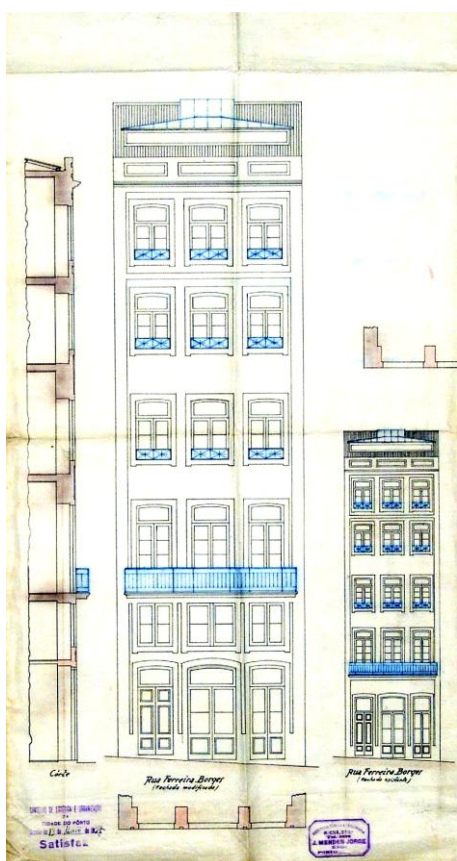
Imagem do projeto de alteração da Fachada Ferreira Borges [6]
